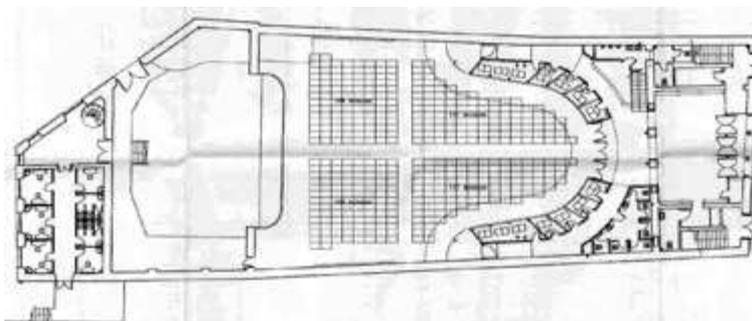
Planta baja reformada [LÓPEZ BERNAL, V., Proyecto de Rehabilitación del Cine Teatro Carolina Coronado de Almendralejo, 2001]
